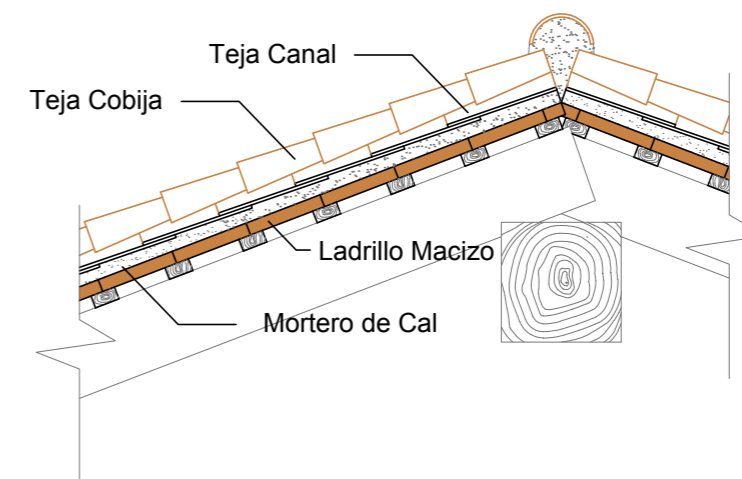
Detalle de cubierta existente. Autor Propio 2016
